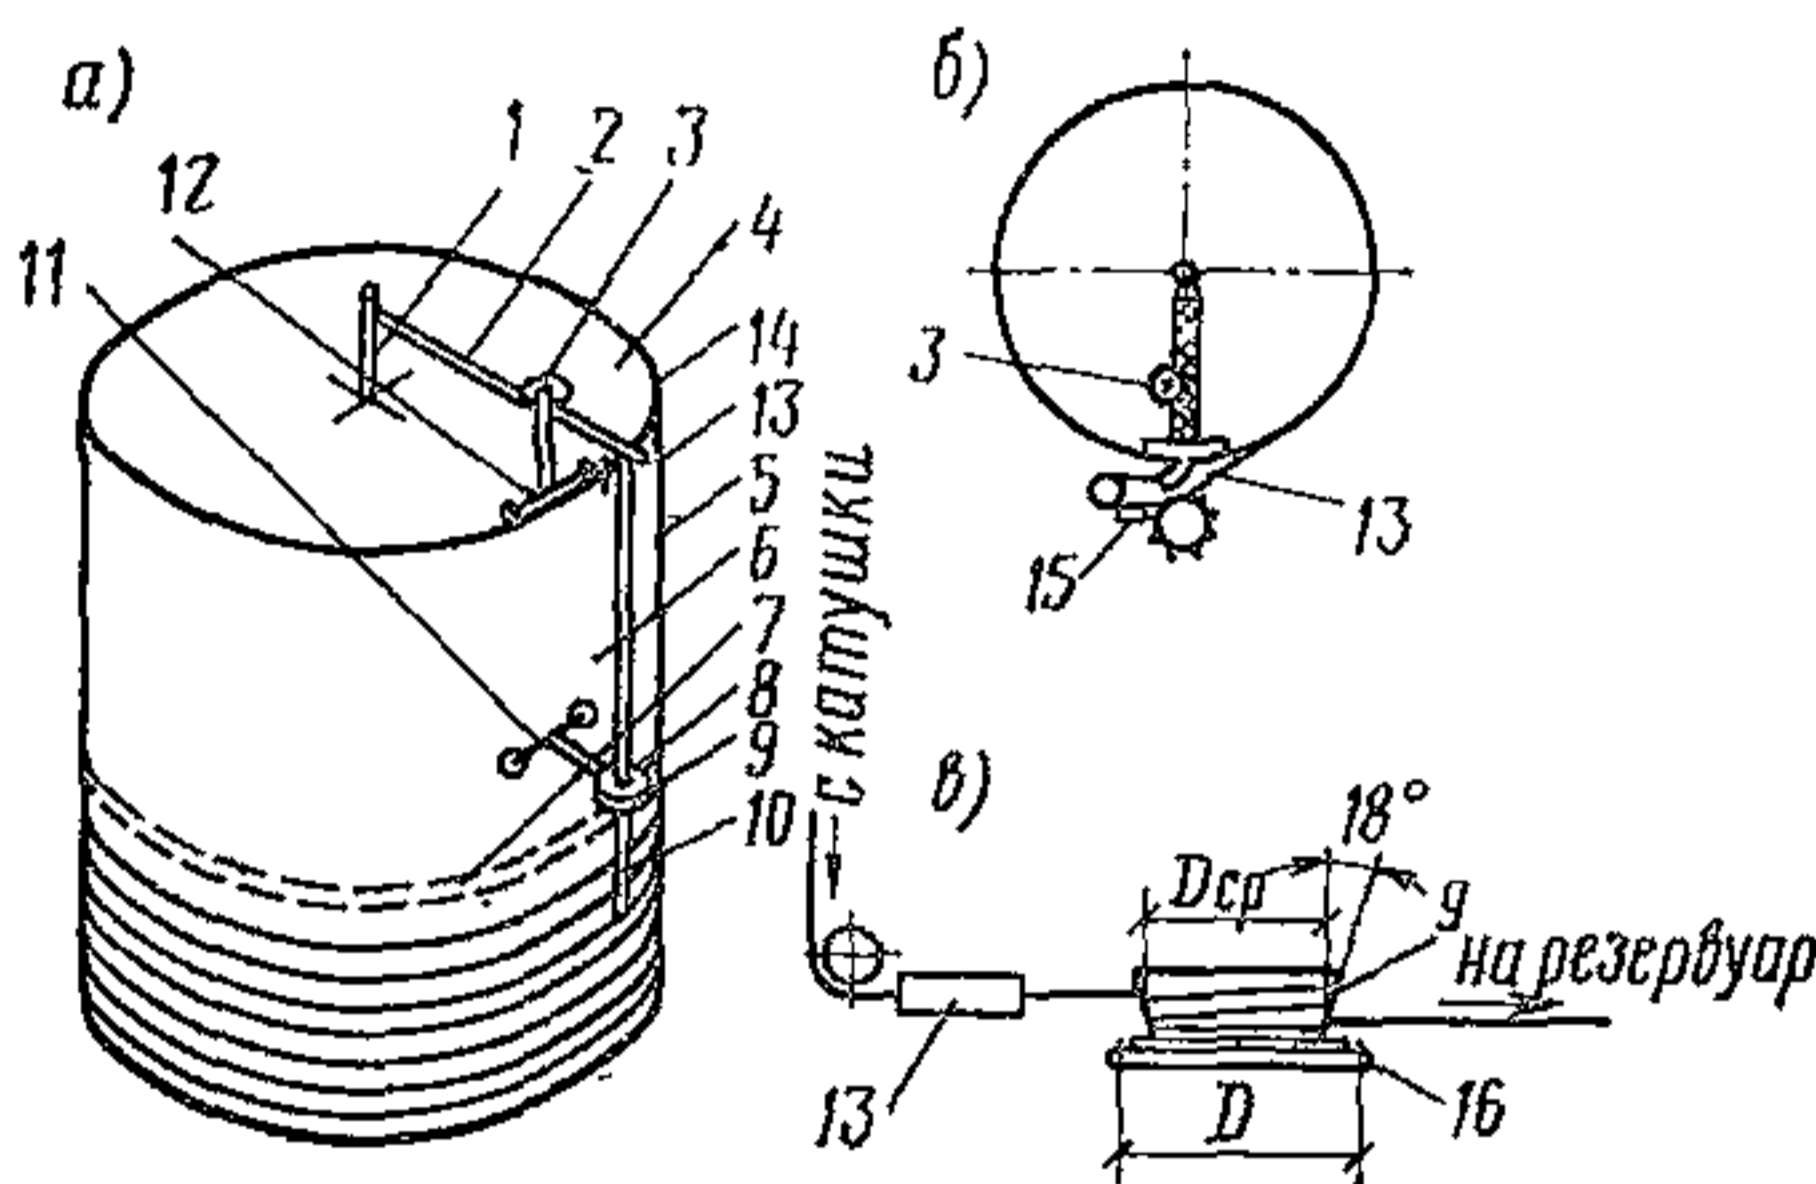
Схемы навивки напряженной проволоки на резервуар
